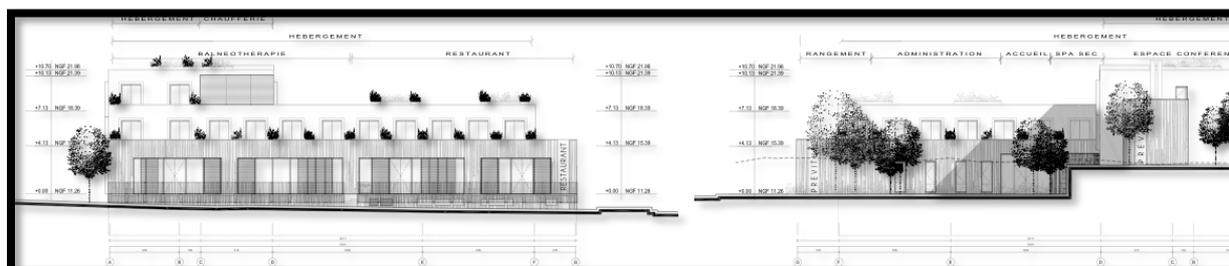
Façade ouest du centre de thalassothérapie Donville-les-bains
